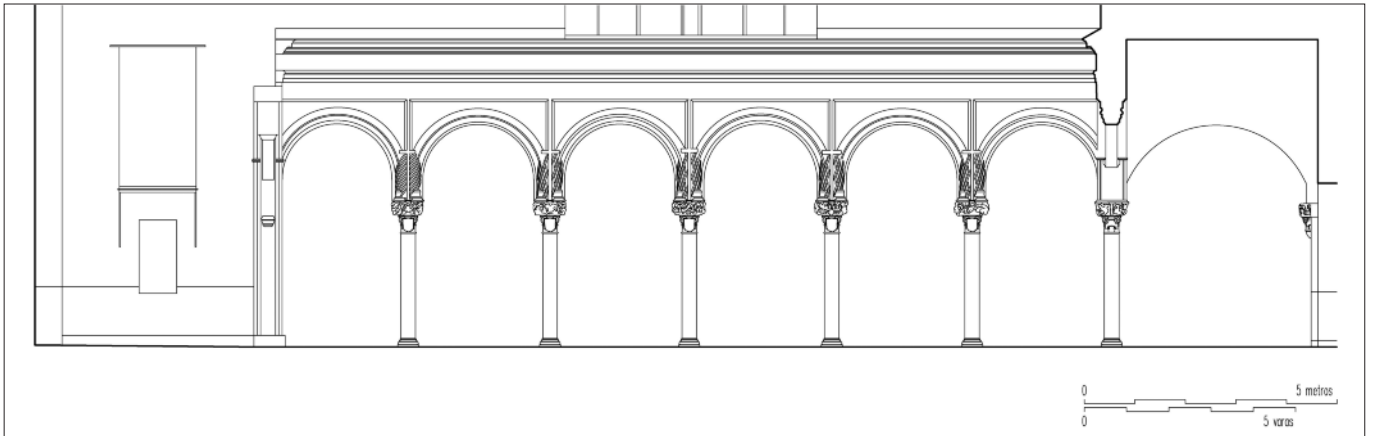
Jerez de la Frontera. Palacio Ponce de León. Alzado galería suroeste.
